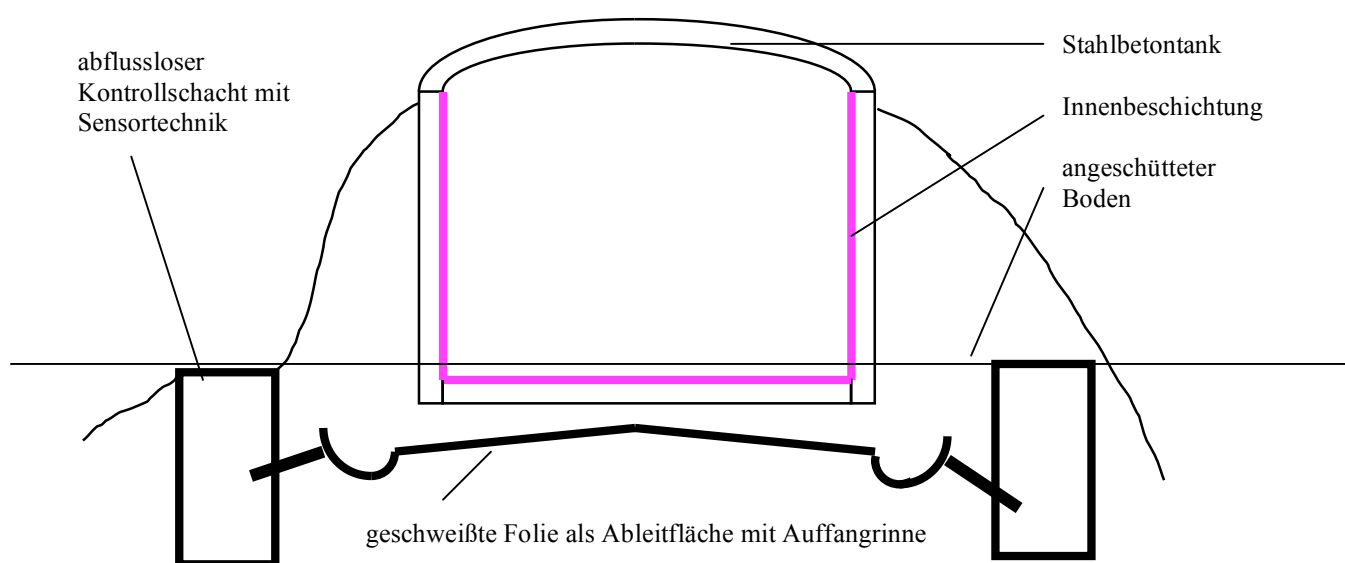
Systemskizze der einwandigen unterirdischen Stahlbetontanks mit Innenbeschichtung
